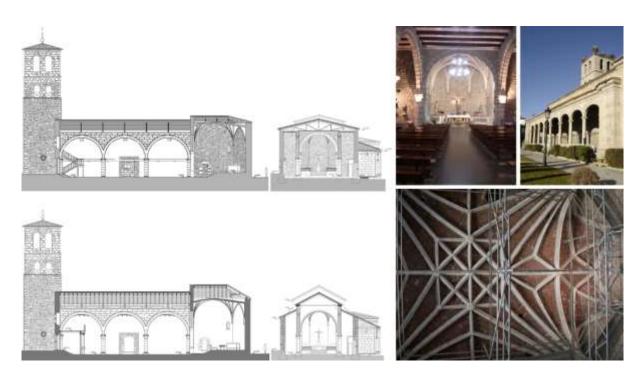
Arriba planos y fotos del estado inicial, abajo planos del proyecto de restauración: cortesía de Antonio Ábalos. Abajo a la derecha imagen de la bóveda objeto de la investigación.
